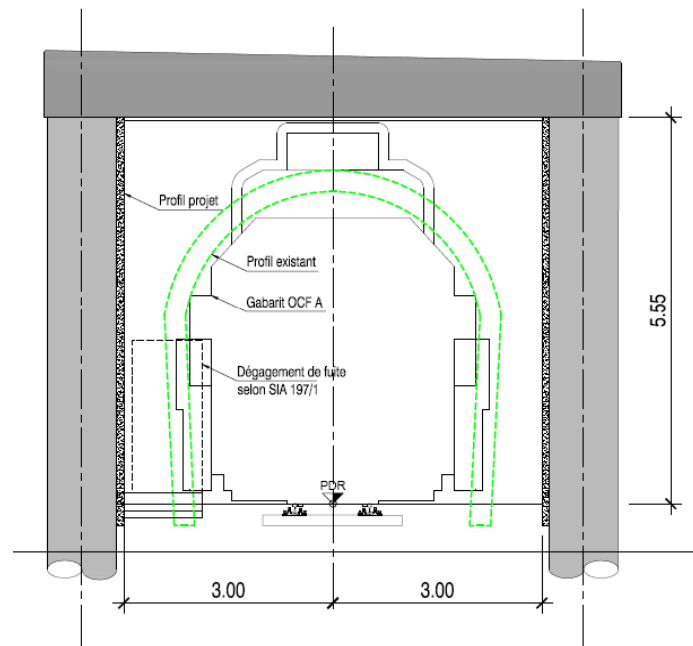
Section type du tunnel projeté réalisé en taupe, avec superposition de la voûte du tunnel existant
